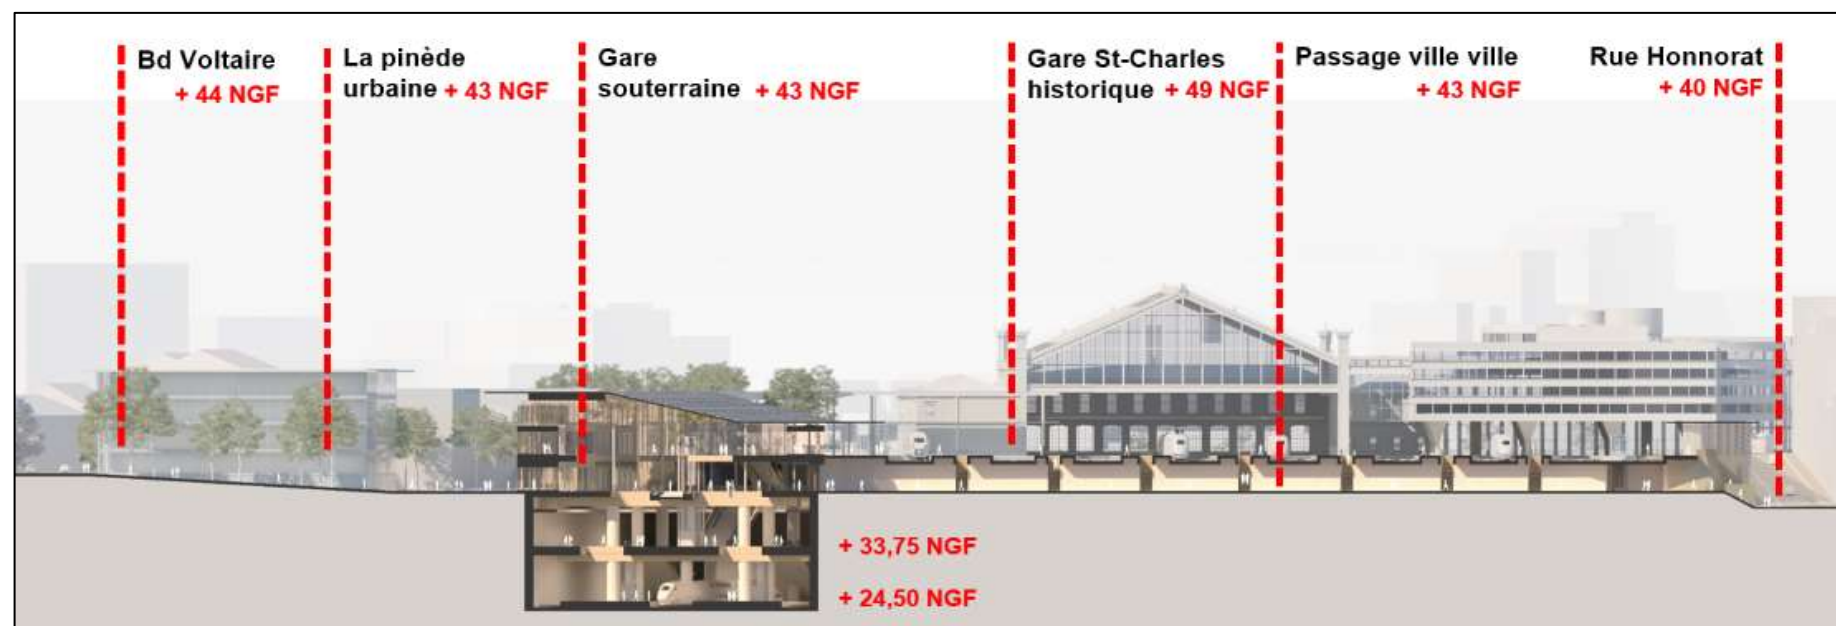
Coupe transversale sur le plateau ferroviaire - projet
